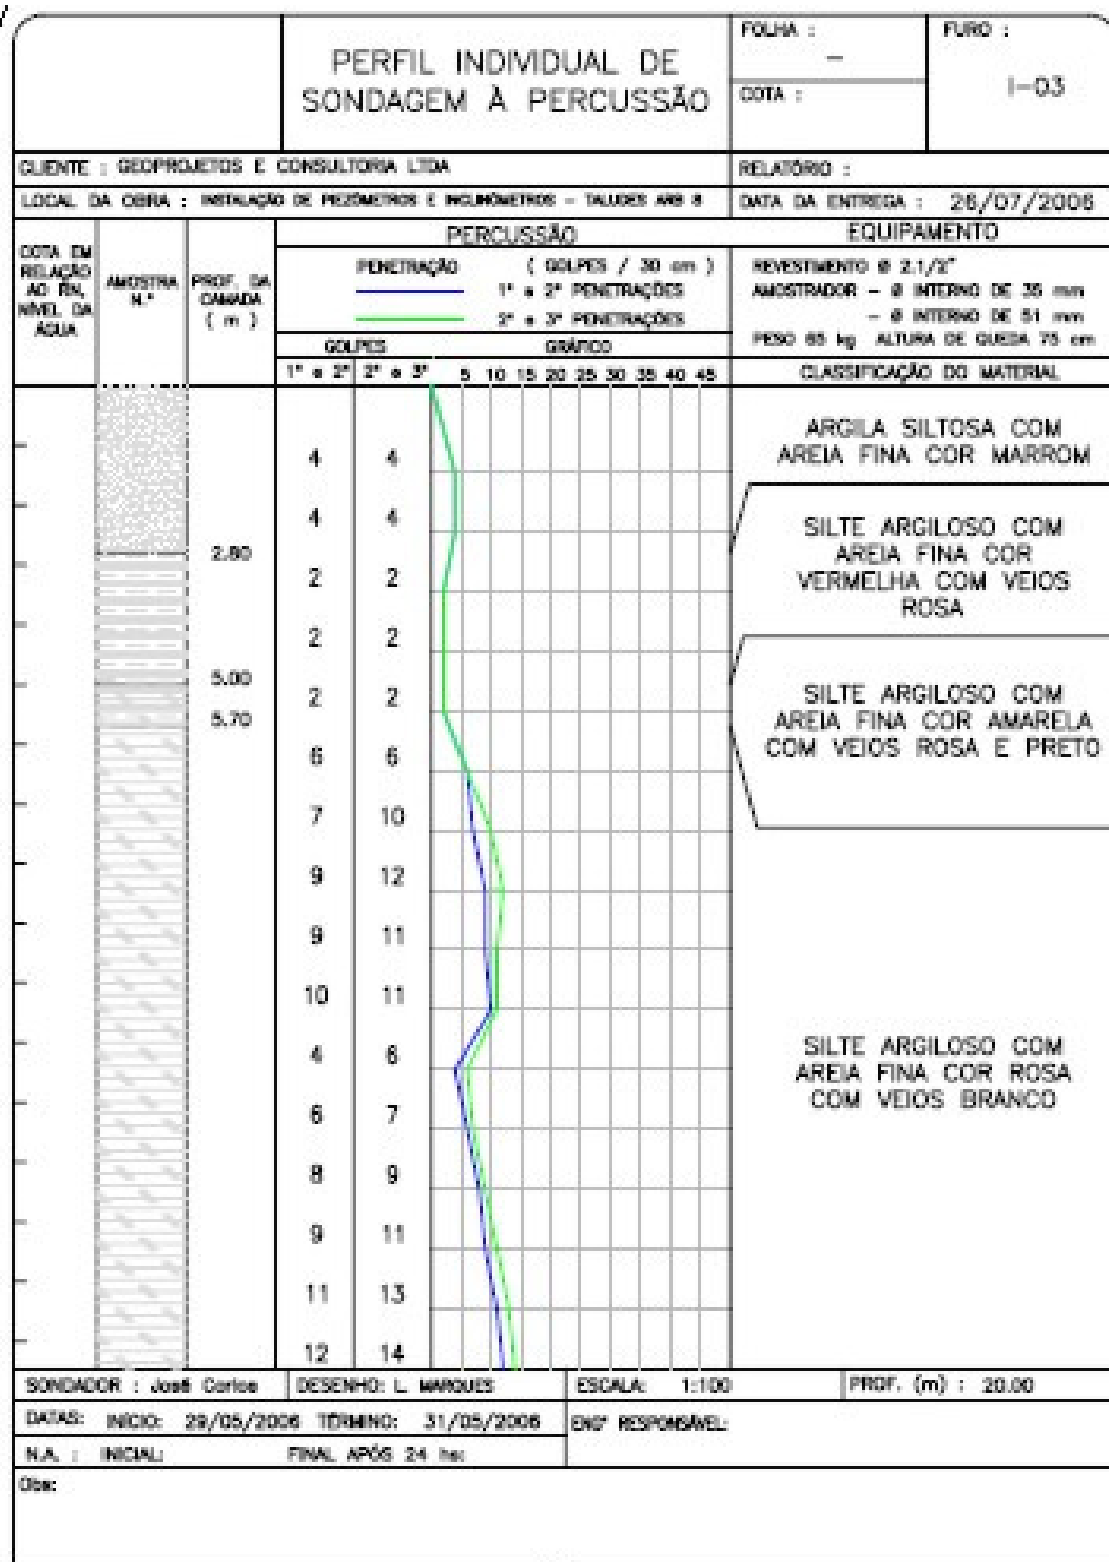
Perfil de sondagem do furo do inclinômetro I-3.
